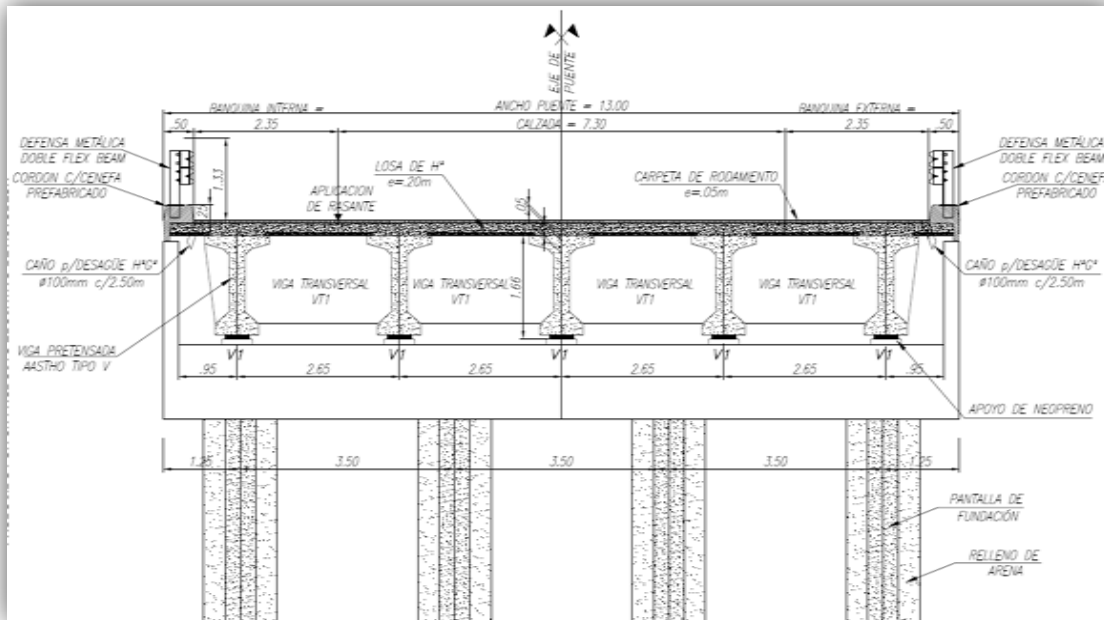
Sección transversal de puente. Vigas prefabricadas, con cabezales superiores para unión monolítica con losa corrida de tablero hormigonada in-situ
